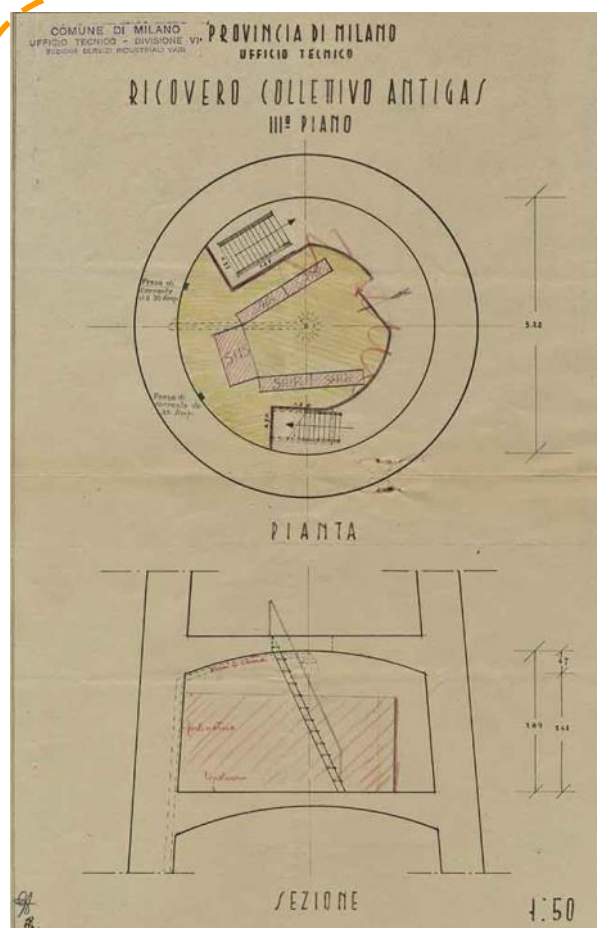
Comune di Milano, Ufficio Tecnico - Divisione VI, Sezione Servizi Industriali vari: I piano in elevato della Torre delle Sirene, ovvero è il terzo partendo dal fondo. Al centro della stanza andranno collocati gli armadi metallici contenenti le installazioni della S.I.S. (Società Italiana Impianti Segnalazioni) e della S.A.I.R. (Società Apparecchi e Impianti a Relé) per mettere in azione le sirene d'allarme installate in città. Osservando le due sezioni si può notare che al centro della stanza vi è, a soffitto, il diffusore dell'aria (Archivio Storico della Provincia).
